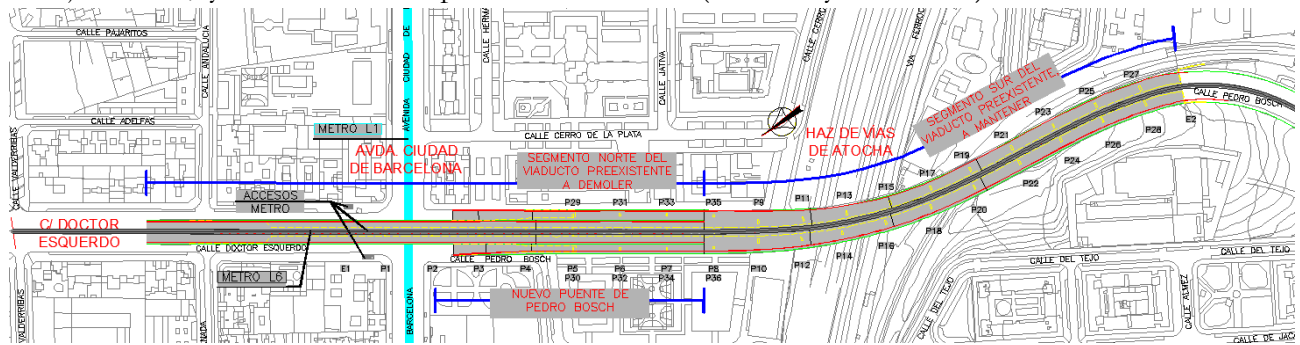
Vista en planta del viaducto preexistente. División en Segmentos: a demoler, y a mantener y remodelar.
